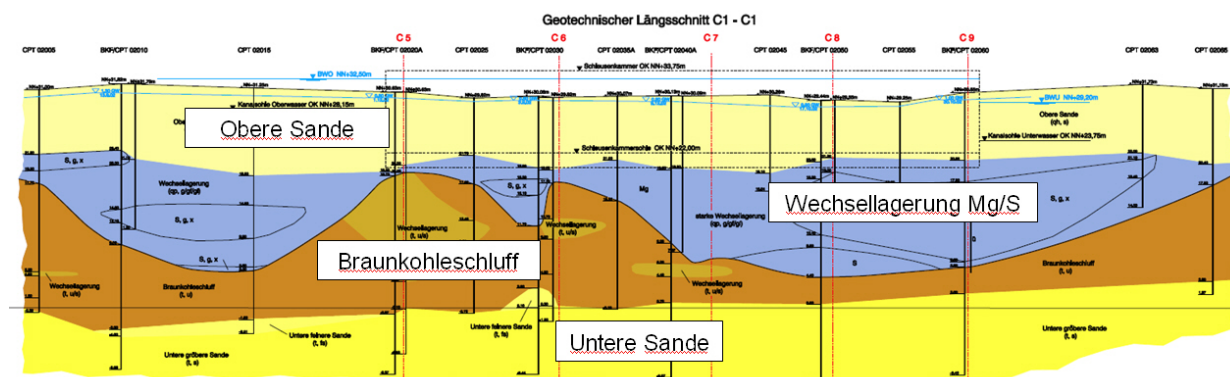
Baugrundaufbau im südlichen Baugrubenbereich
